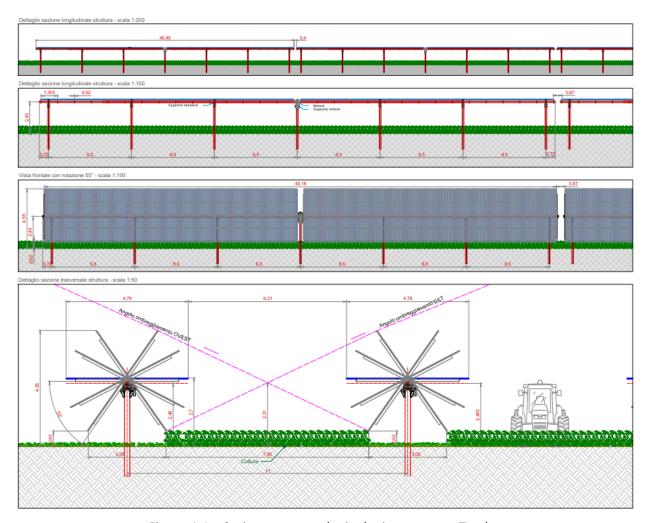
Sezione trasversale tipologica struttura Tracker
